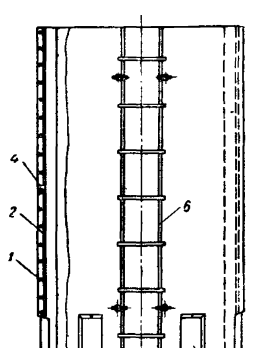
Железобетонная царга сборной предварительно напряженной дымовой трубы
